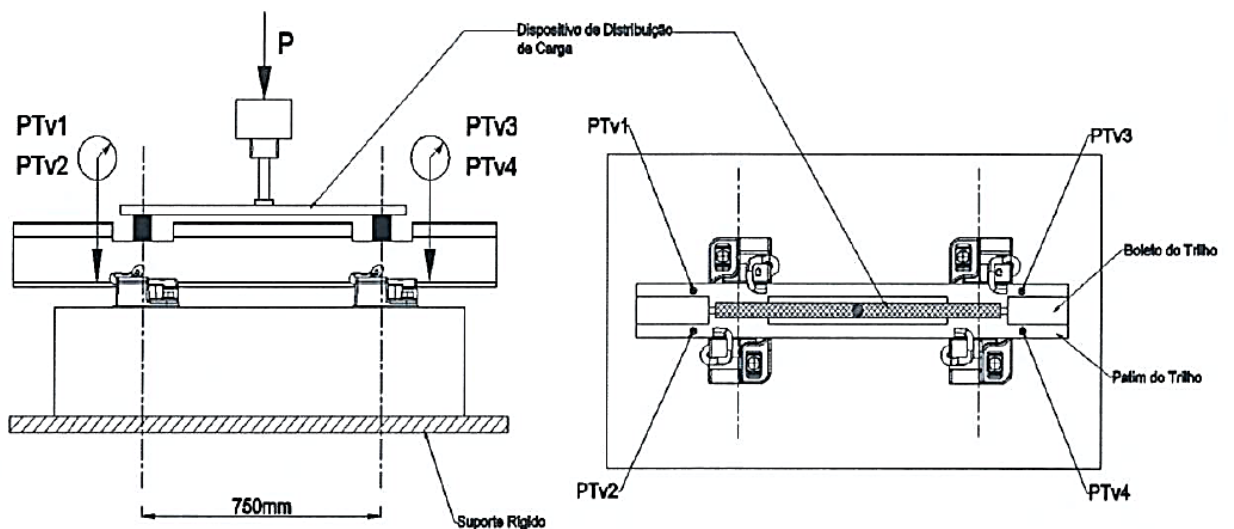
Configuração para Ensaio de Rigidez Vertical do Conjunto
